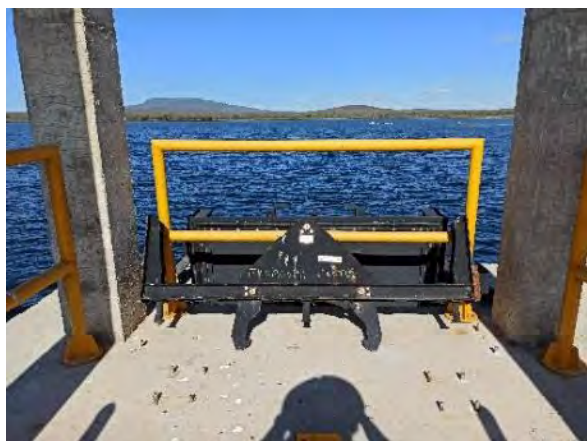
Barragem Salgueiro – Torre da TUD
